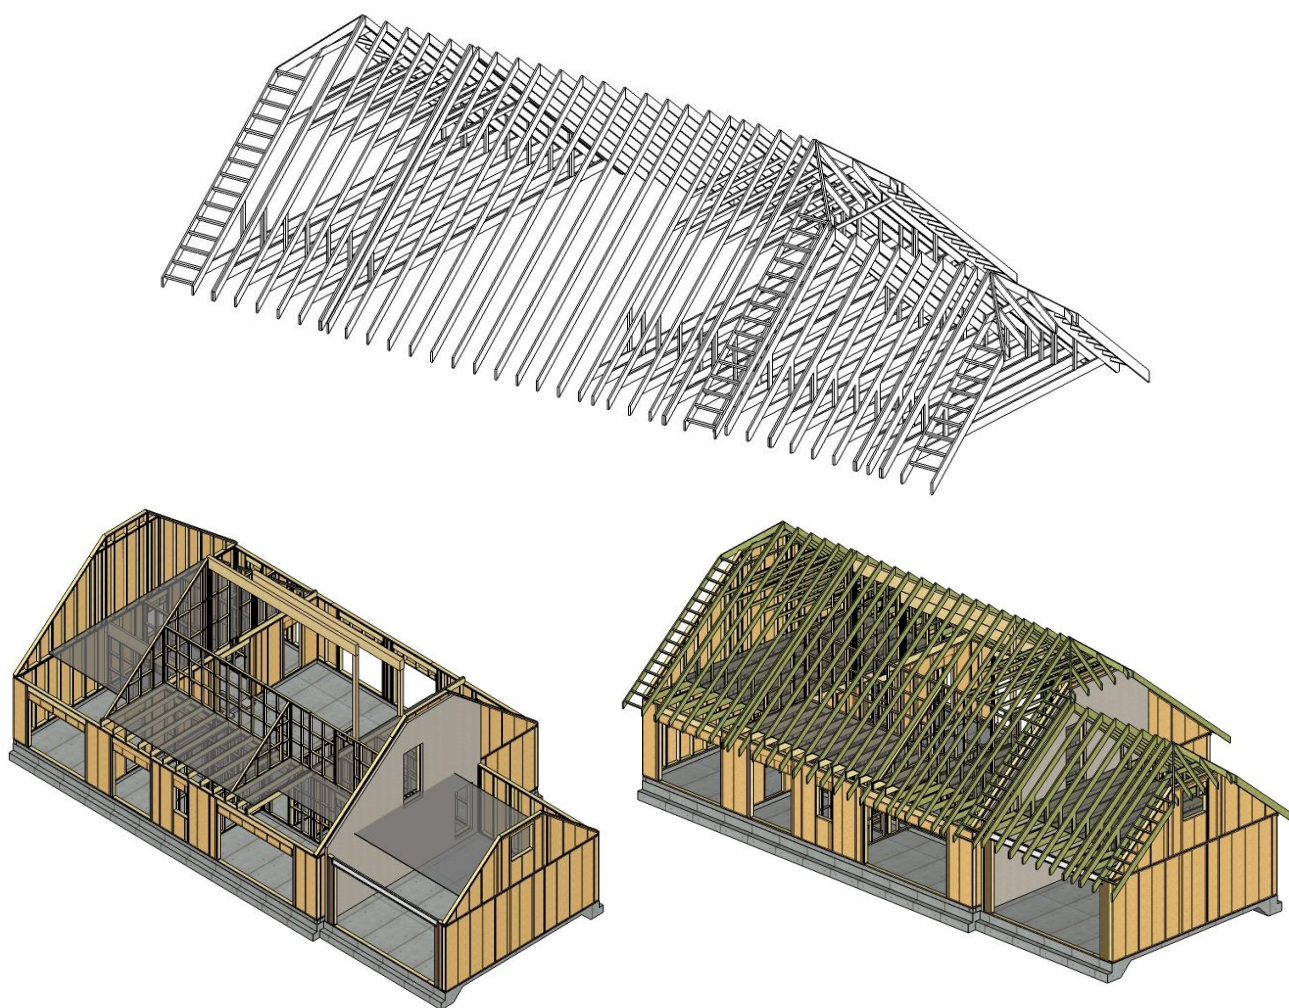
Modelo em SketchUp da elevação do primeiro piso e instalação da cobertura, em *Timber Frame
